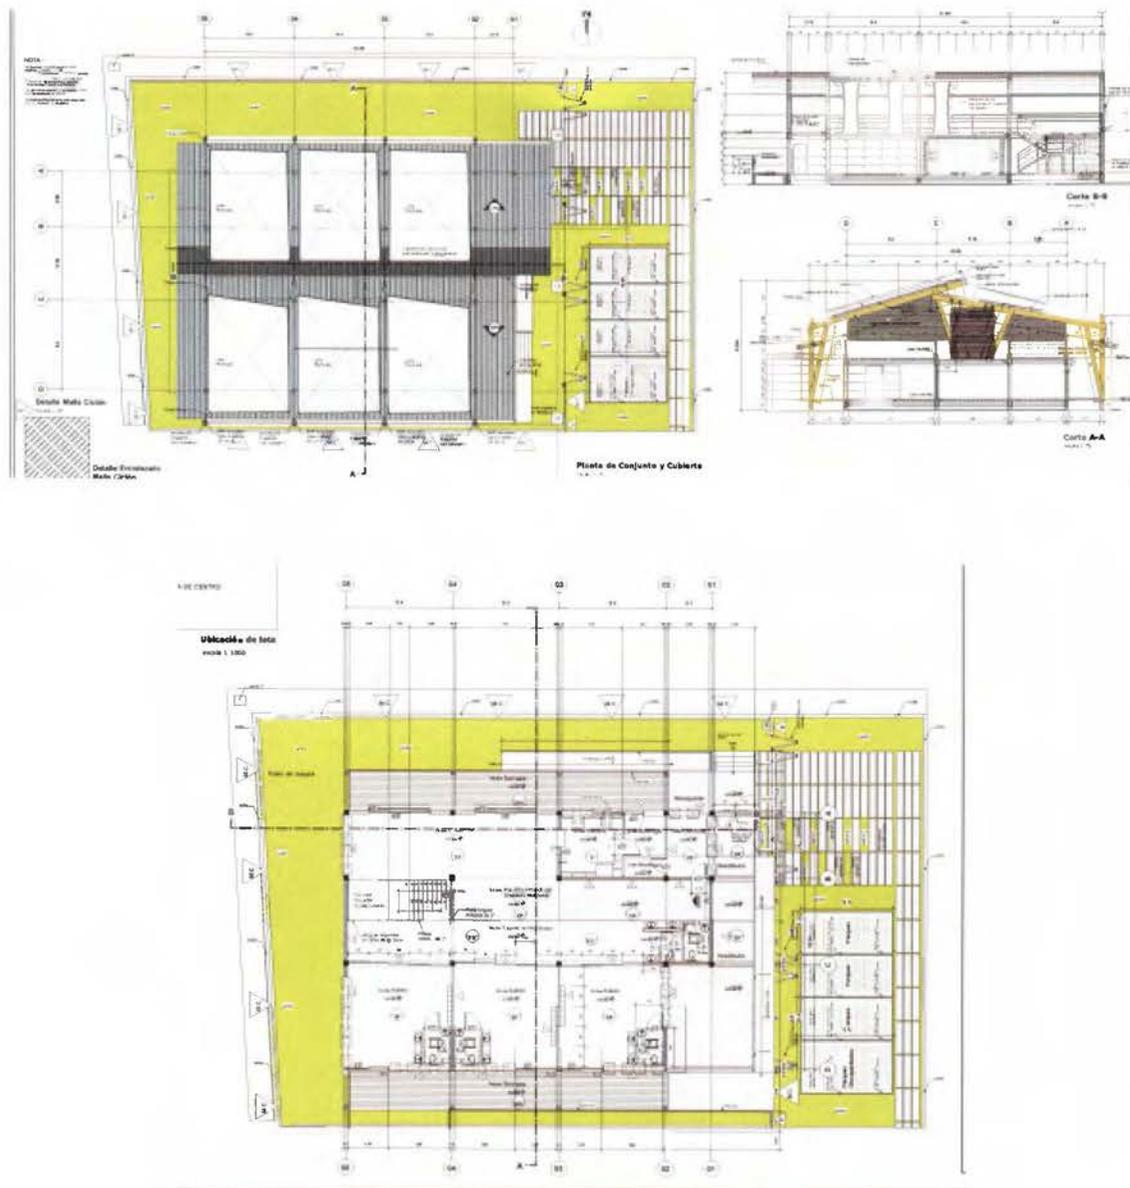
Planimetría del CECUDI: Planta arquitectónica, planta de conjunto y cubierta, Corte A-A y Corte B-B. Fuente: EntreNos Atelier, Michael Smith.
